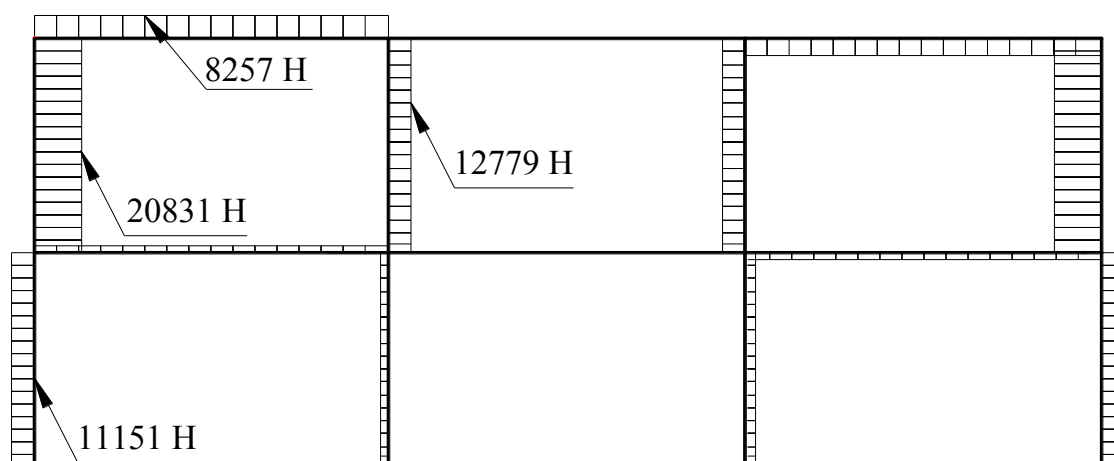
Эпюра поперечных сил для 3 Варианта тепловой нагрузки
